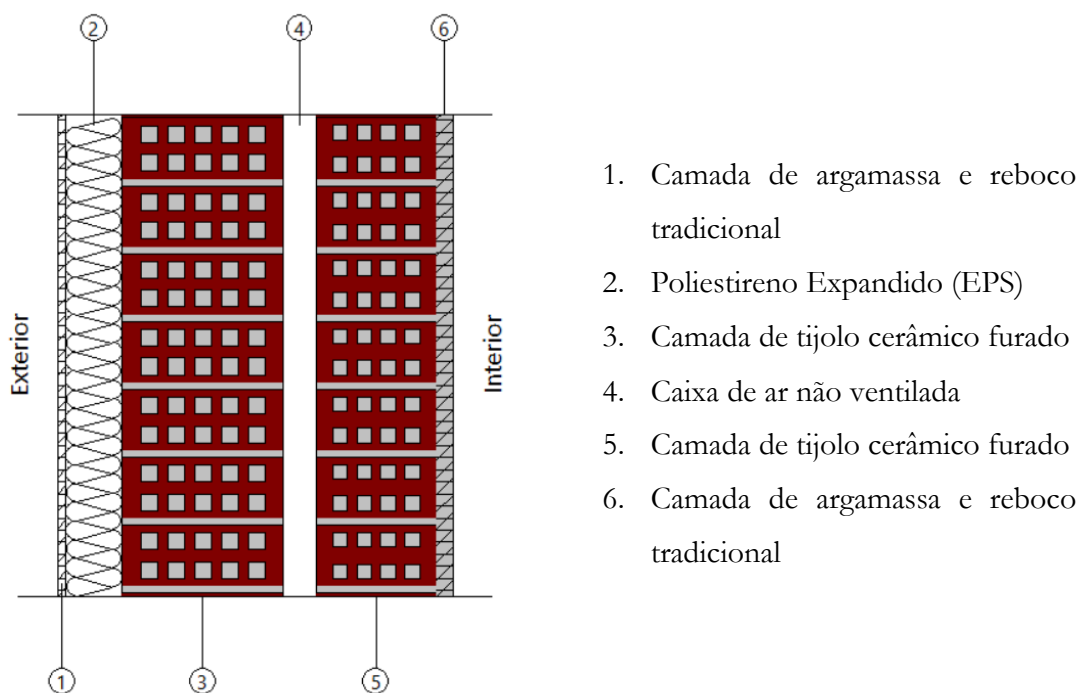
Esquema da parede exterior com aplicação de isolamento.
